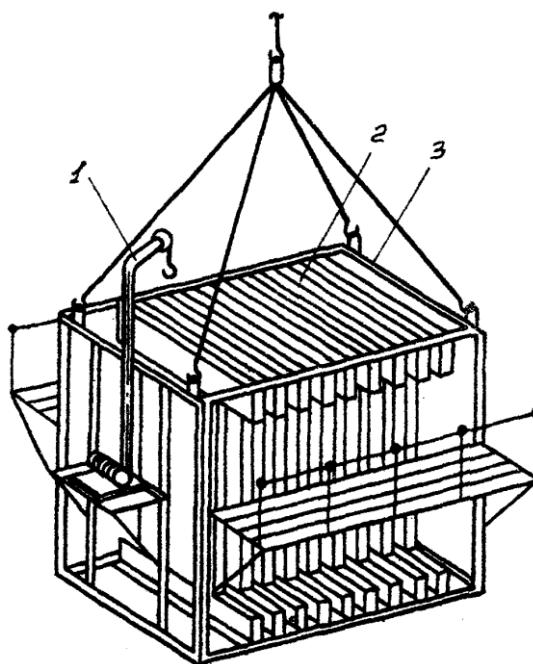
Контейнер для дверей шахты, оборудованный грузоподъемным устройством:
